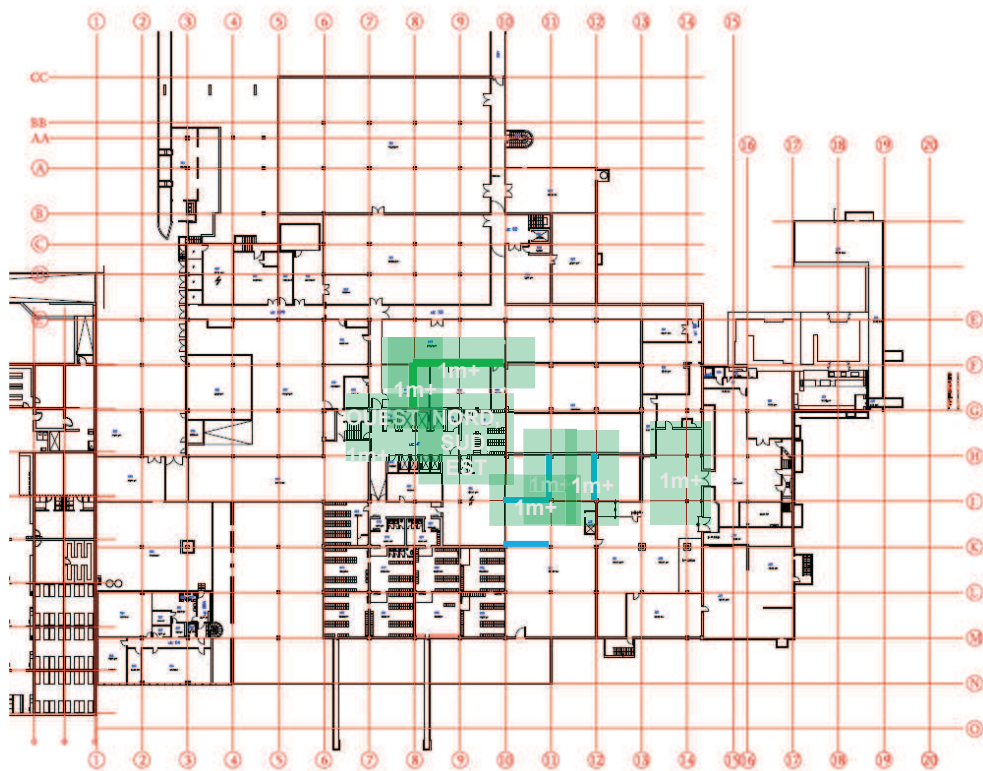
Plan du sous-sol, niveau U. Fondations superficielles indicatives.
